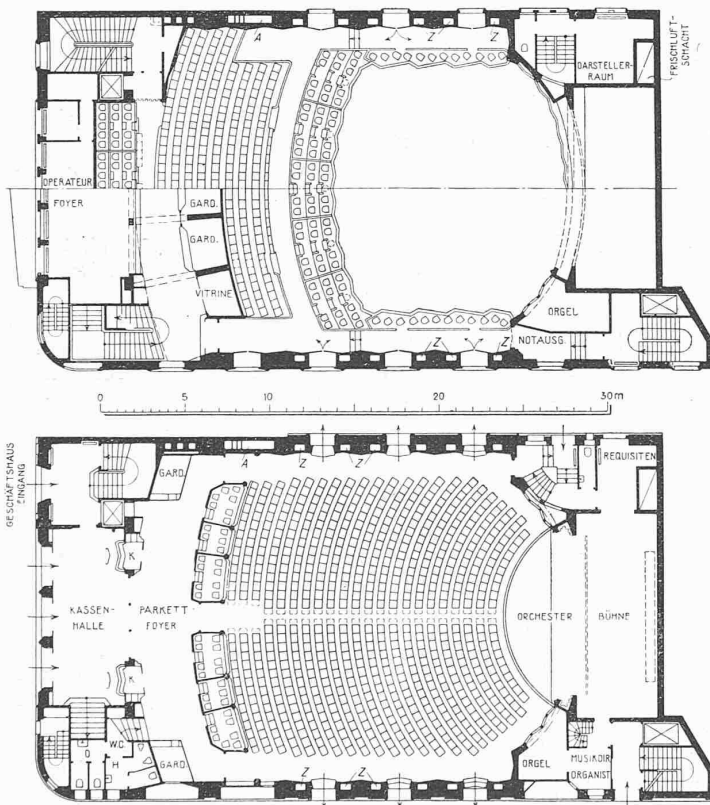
und 7. Grundrisse von Parterre und Galerie. — Masstab 1 : 400.
